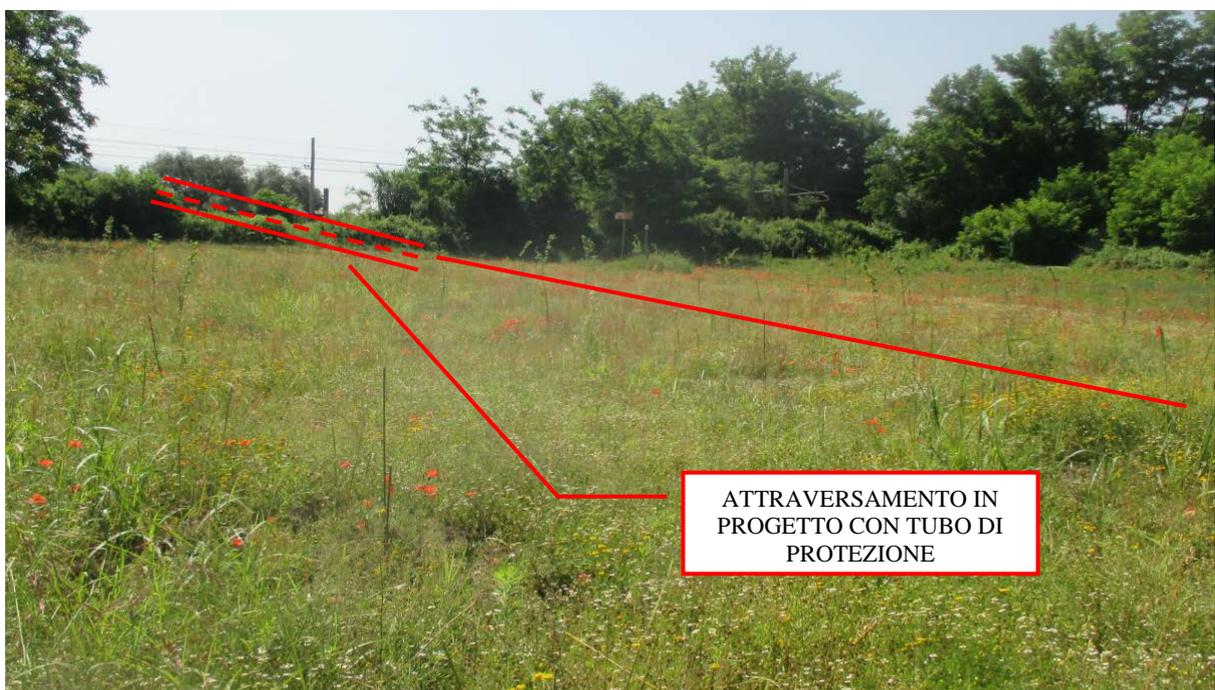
Vista dell'attraversamento in tubo di protezione della Ferrovia NA-FG esistente
